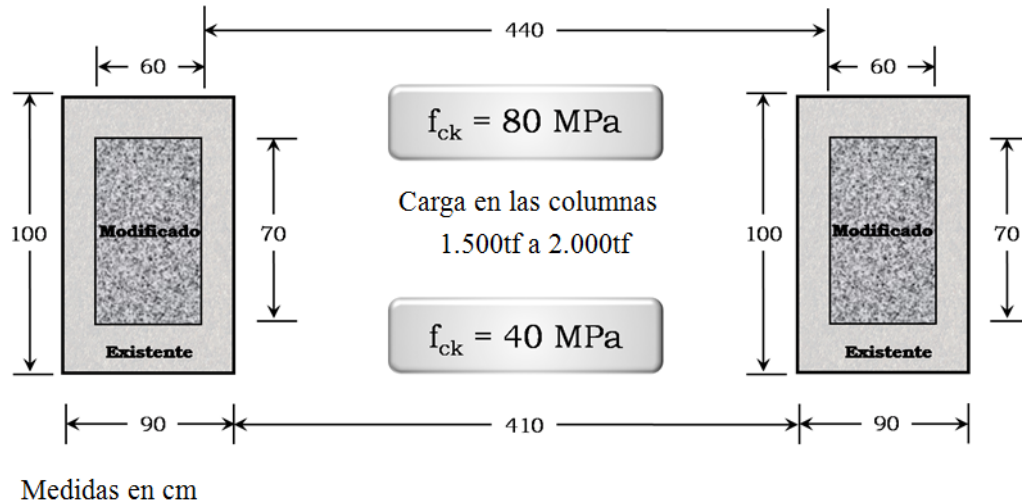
Edificio *e-Tower*: columnas existentes en el proyecto original de $f_{ck} = 40\text{MPa}$ (90cm x 100cm) y columnas modificadas con $f_{ck} 80\text{MPa}$ (60cm x 70cm)
